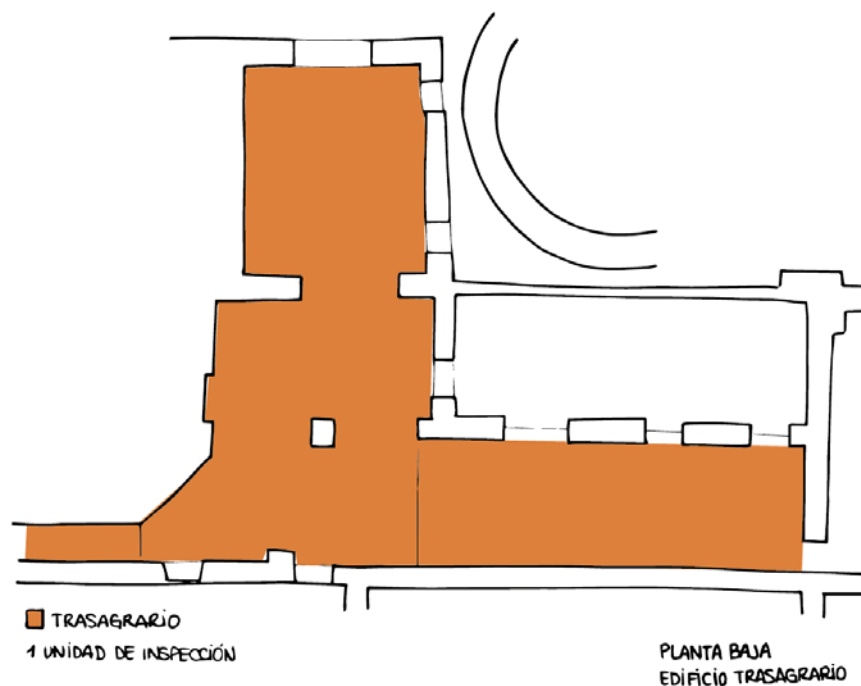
Ámbito de actuación y unidades de inspección en la planta baja del edificio Trasagrario.
